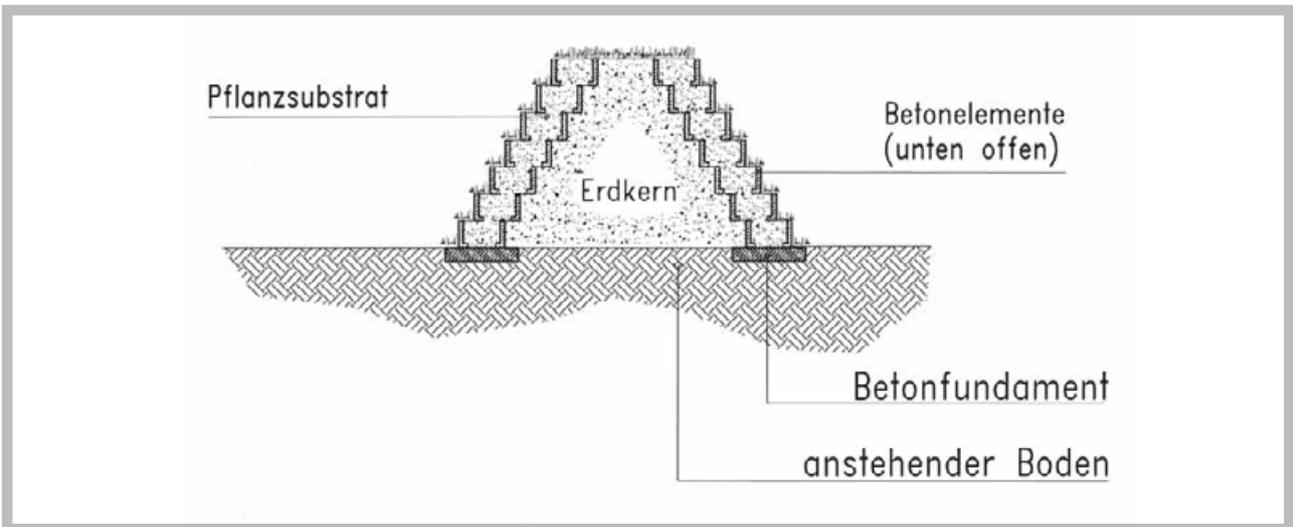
Schematisierter Aufbau der Wallsysteme mit oben geöffneten Betonkammern, Neigung der Systeme: ca. 70°
